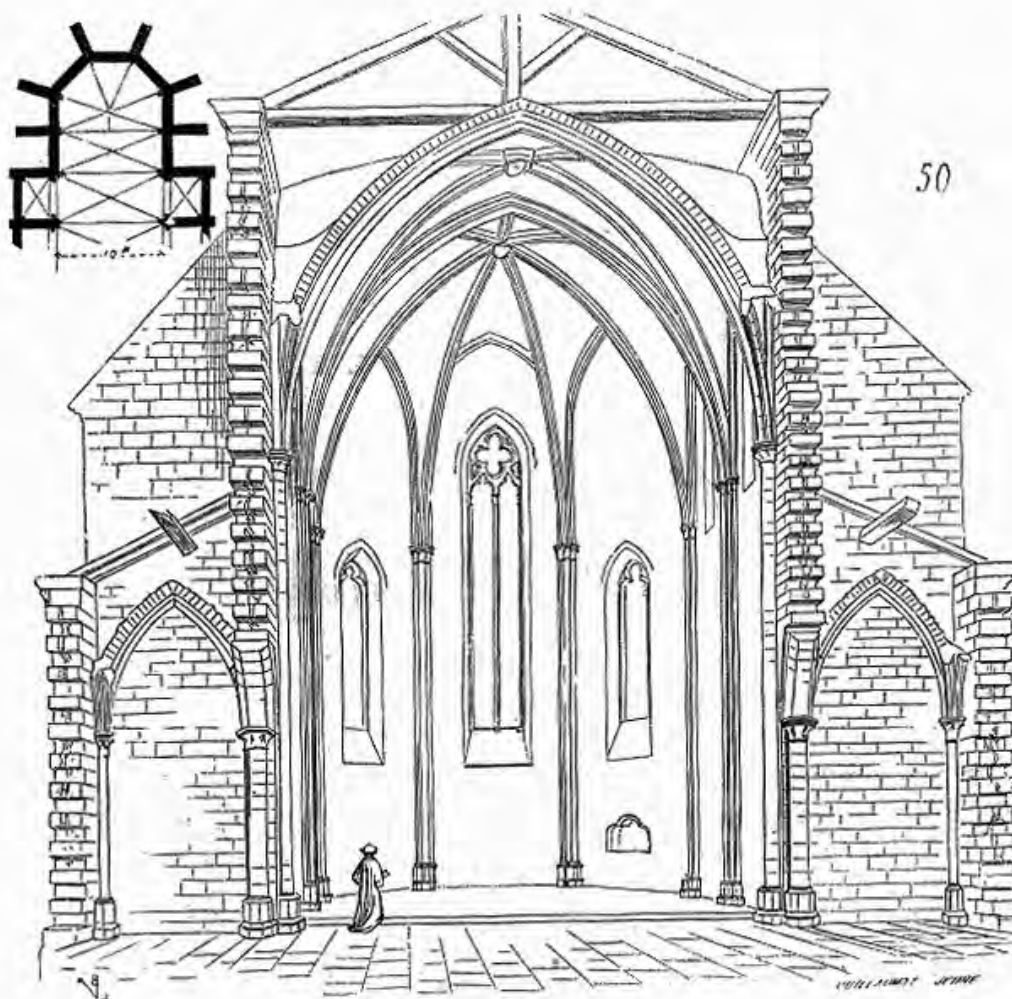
Coupe et plan de la collégiale Saint-Martin, dressés par Viollet-le-Duc en 1841.
